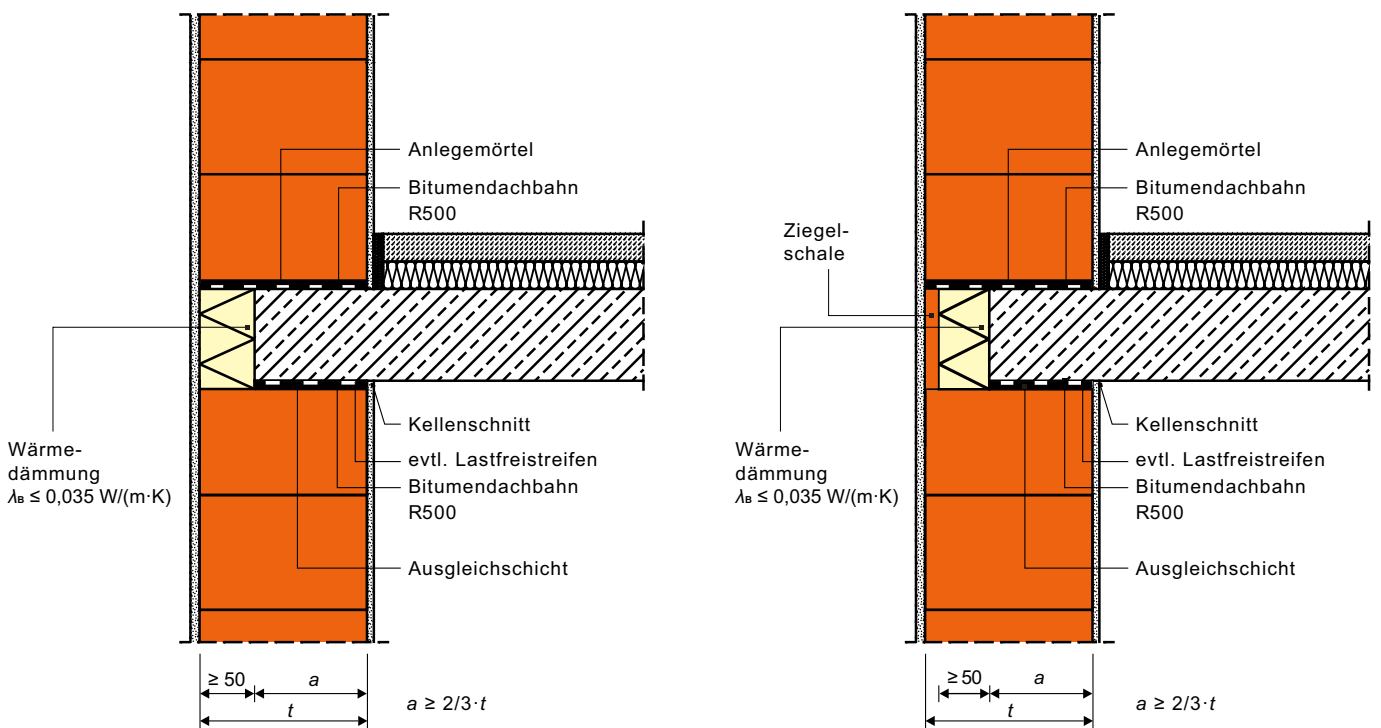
Ausführungsvarianten eines Außenwand-Decken-Knotens mit monolithischem Ziegelmauerwerk; links Deckenstirndämmung, rechts Ziegelschale mit zusätzlicher Wärmedämmung
